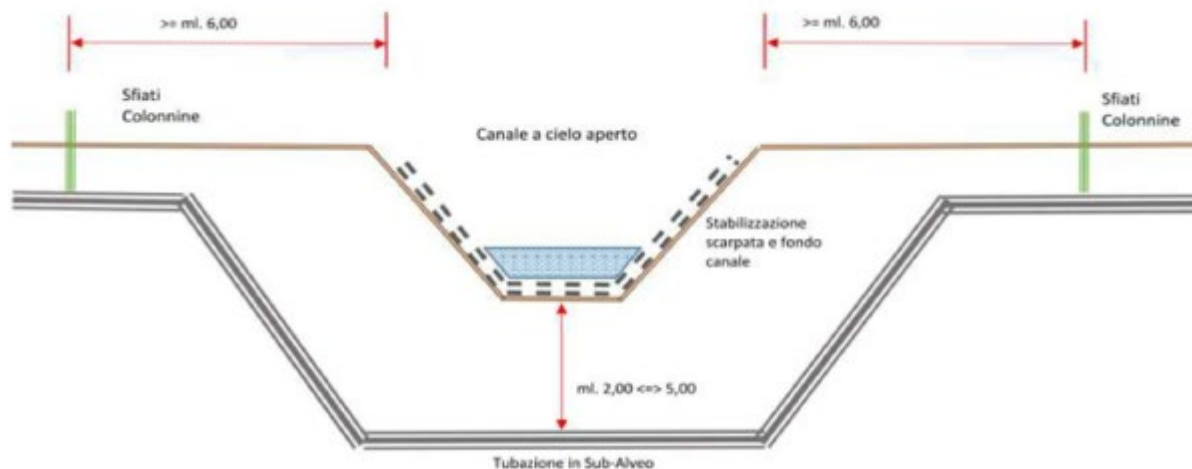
Attraversamento tipo secondo il consorzio di bonifica pianura di Ferrara
